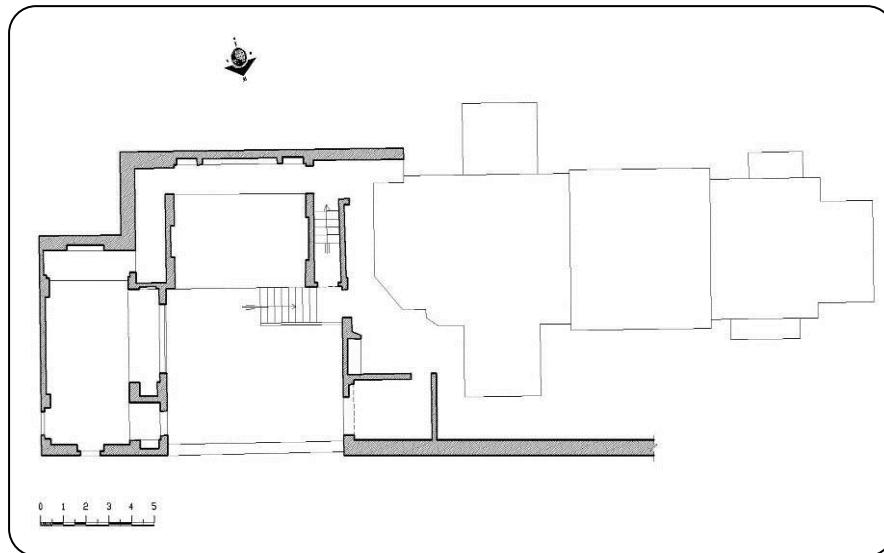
المسقط الأفقي للدور الأرضي لبيت الكريديلية م ١٦٣١ هـ ١٠٤١ م
